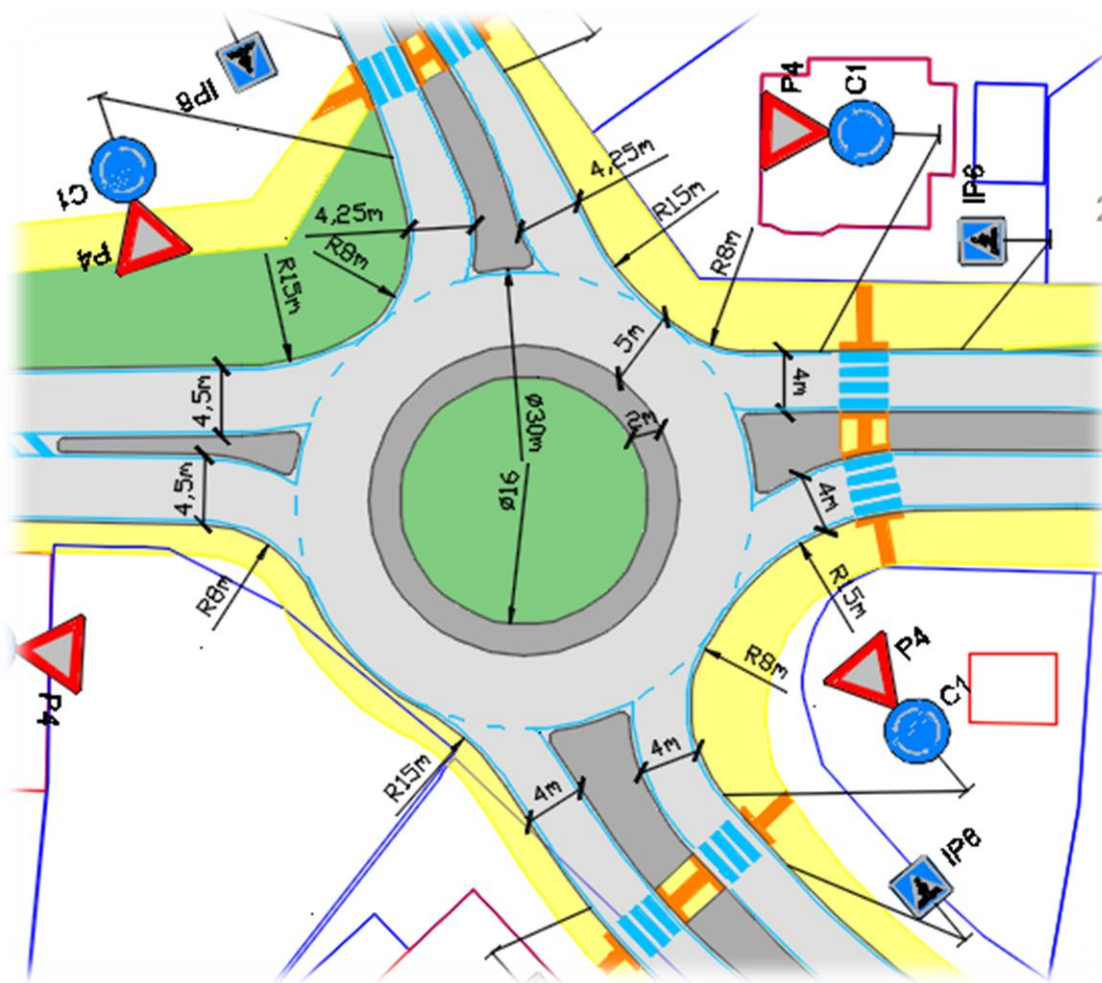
OK varianta č. 2 - detail - jižní větev (vytvořil Ptáček 2016)
